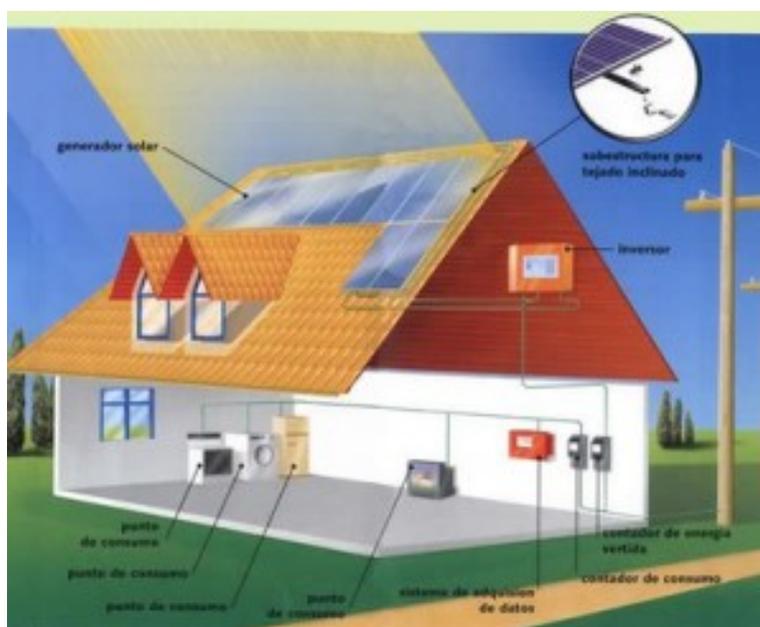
Instalación Fotovoltaica Alterna para viviendas
